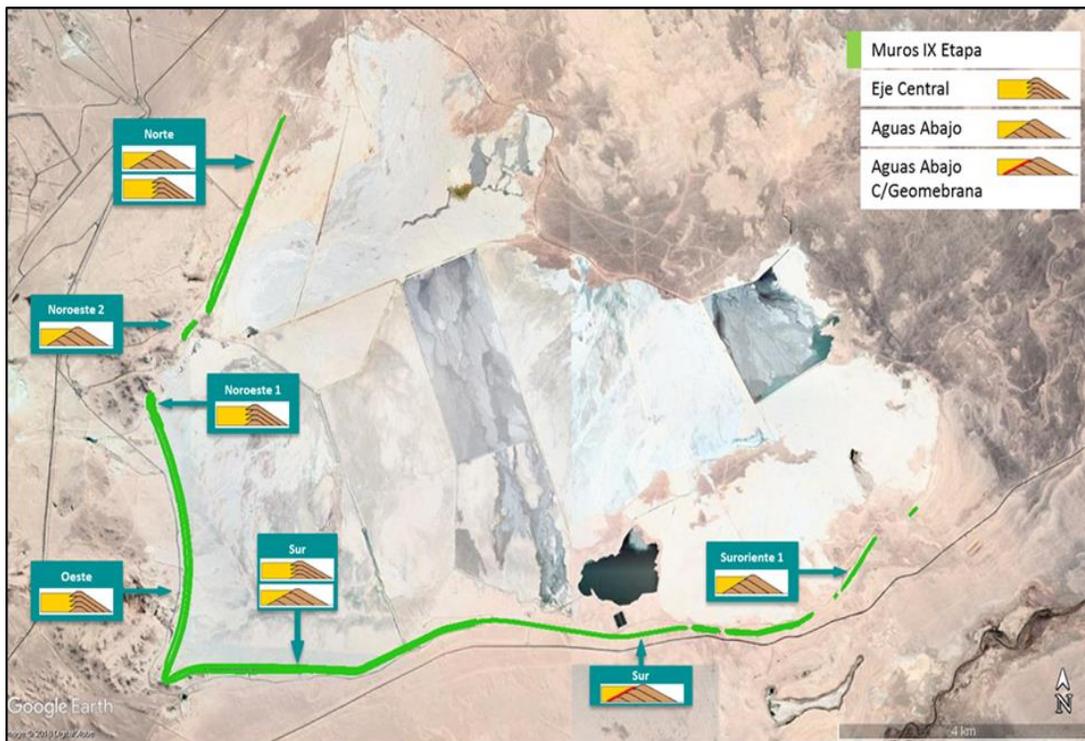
Disposición general de muros perimetrales según secciones tipo.
